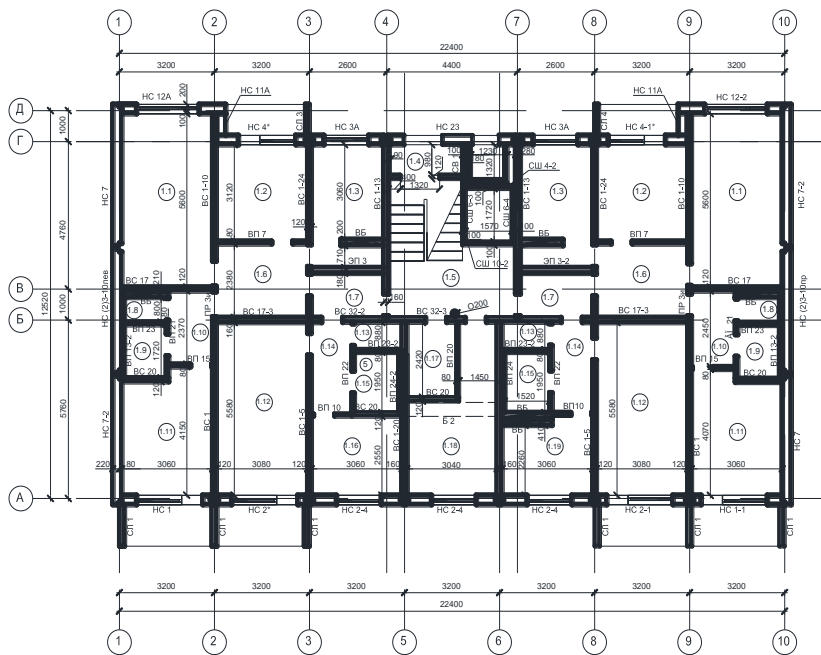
План первого этажа крупнопанельного 9-и этажного здания по серии 121 [4]
